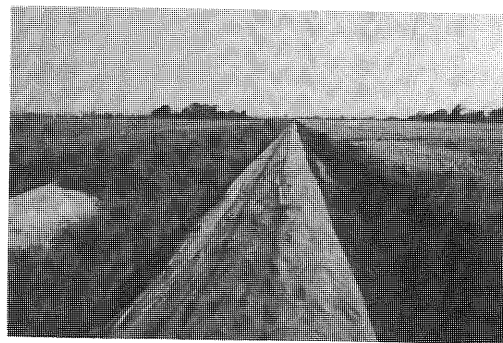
耐久性保護シート(中央)および土壌モルタル(左)の水路法面への施工例
